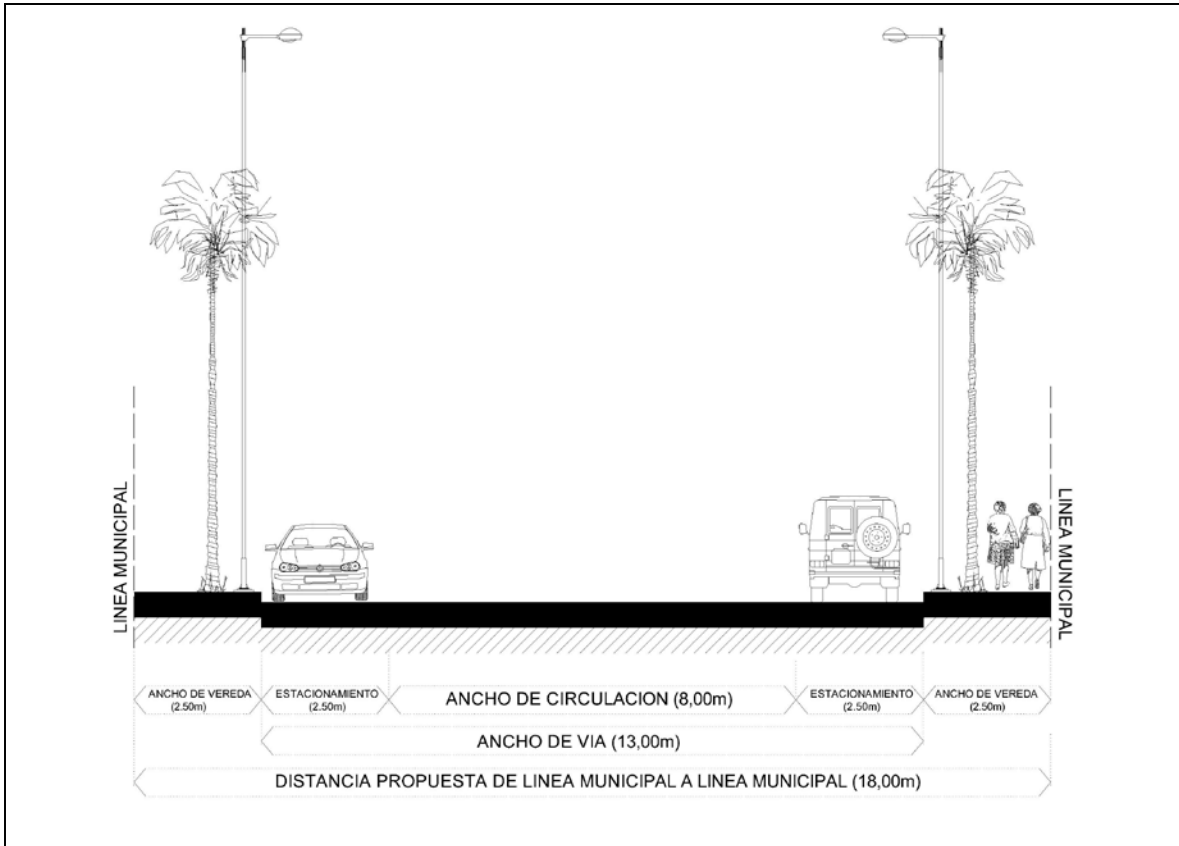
Perfil propuesto para avenida Tucumán en tramo a construir
